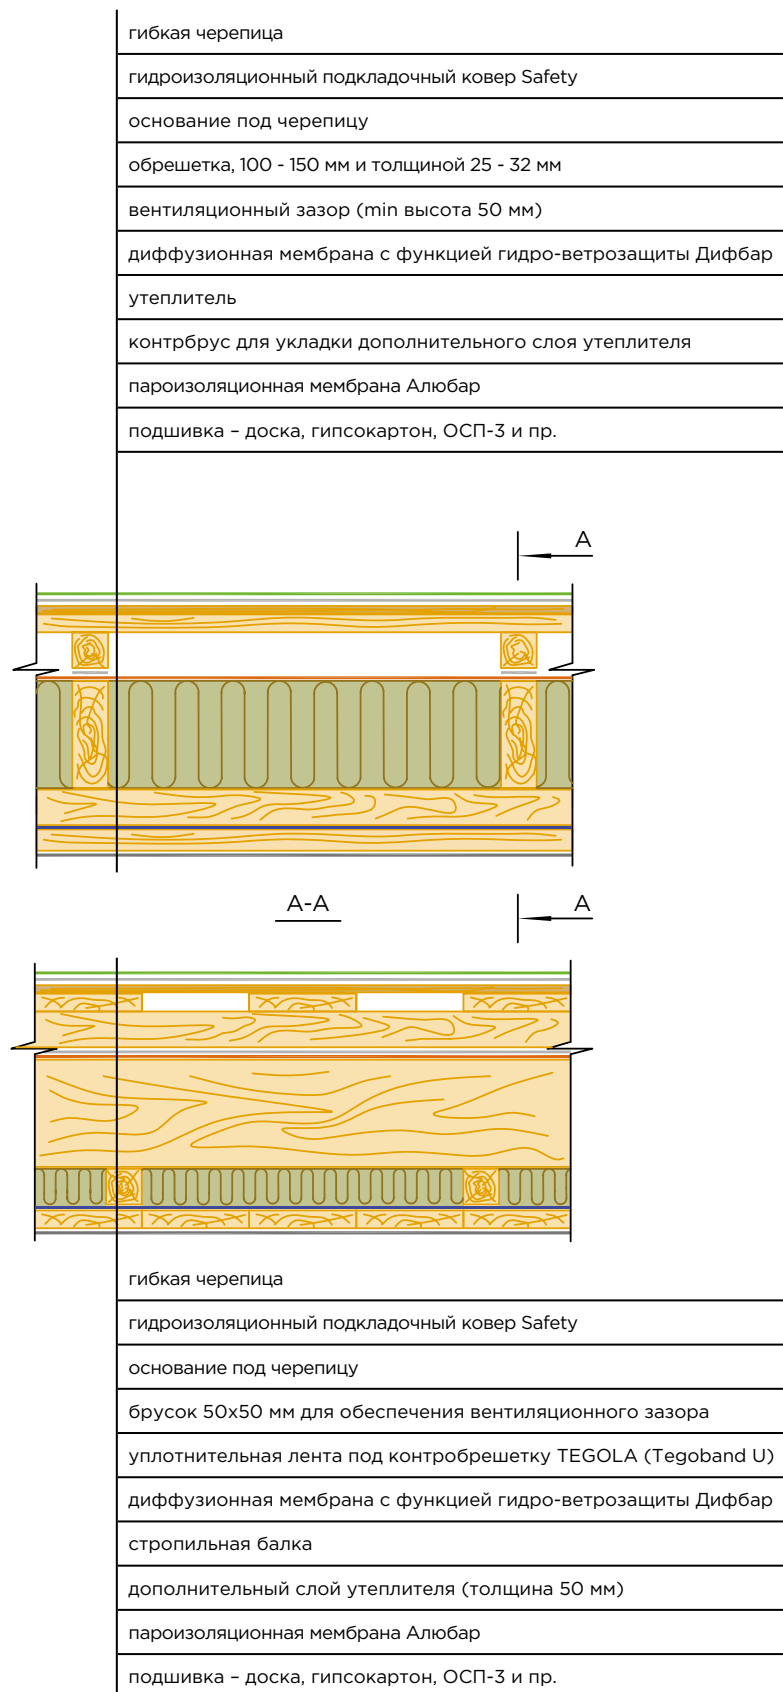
Вариант конструкции крыши мансарды (контрутепление со стороны теплого помещения)
